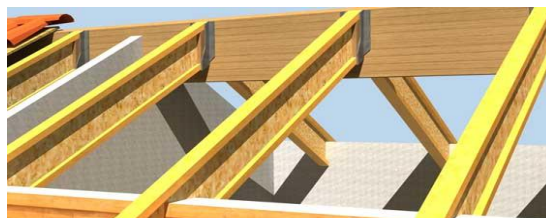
Exemple de poutres composites en I (solivages de plancher et pannes)
